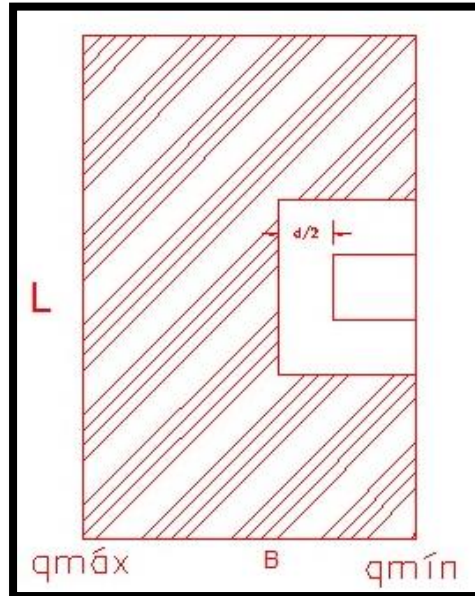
Esquema de zapata colindante con sección crítica para cálculo de cortante por punzonamiento.
